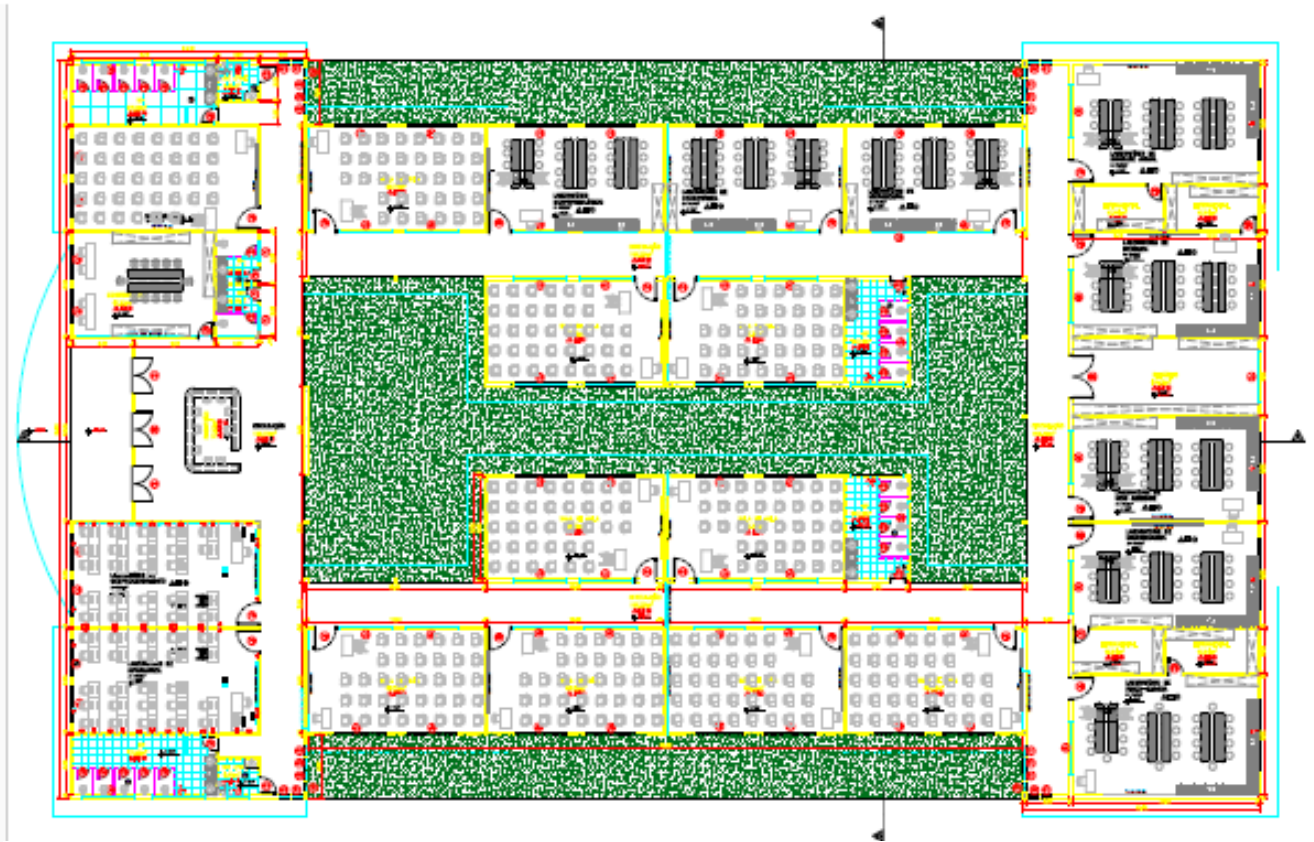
Planta baixa do projeto do Pavilhão das Graduações do IF Baiano, *Campus* Santa Inês.
